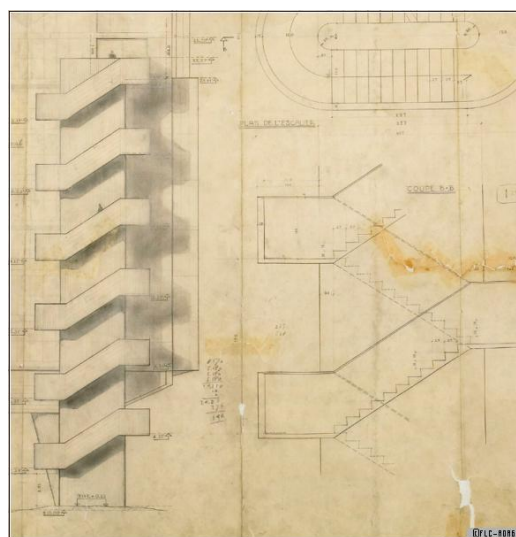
Estudo da Fachada Norte com a escada em betão
